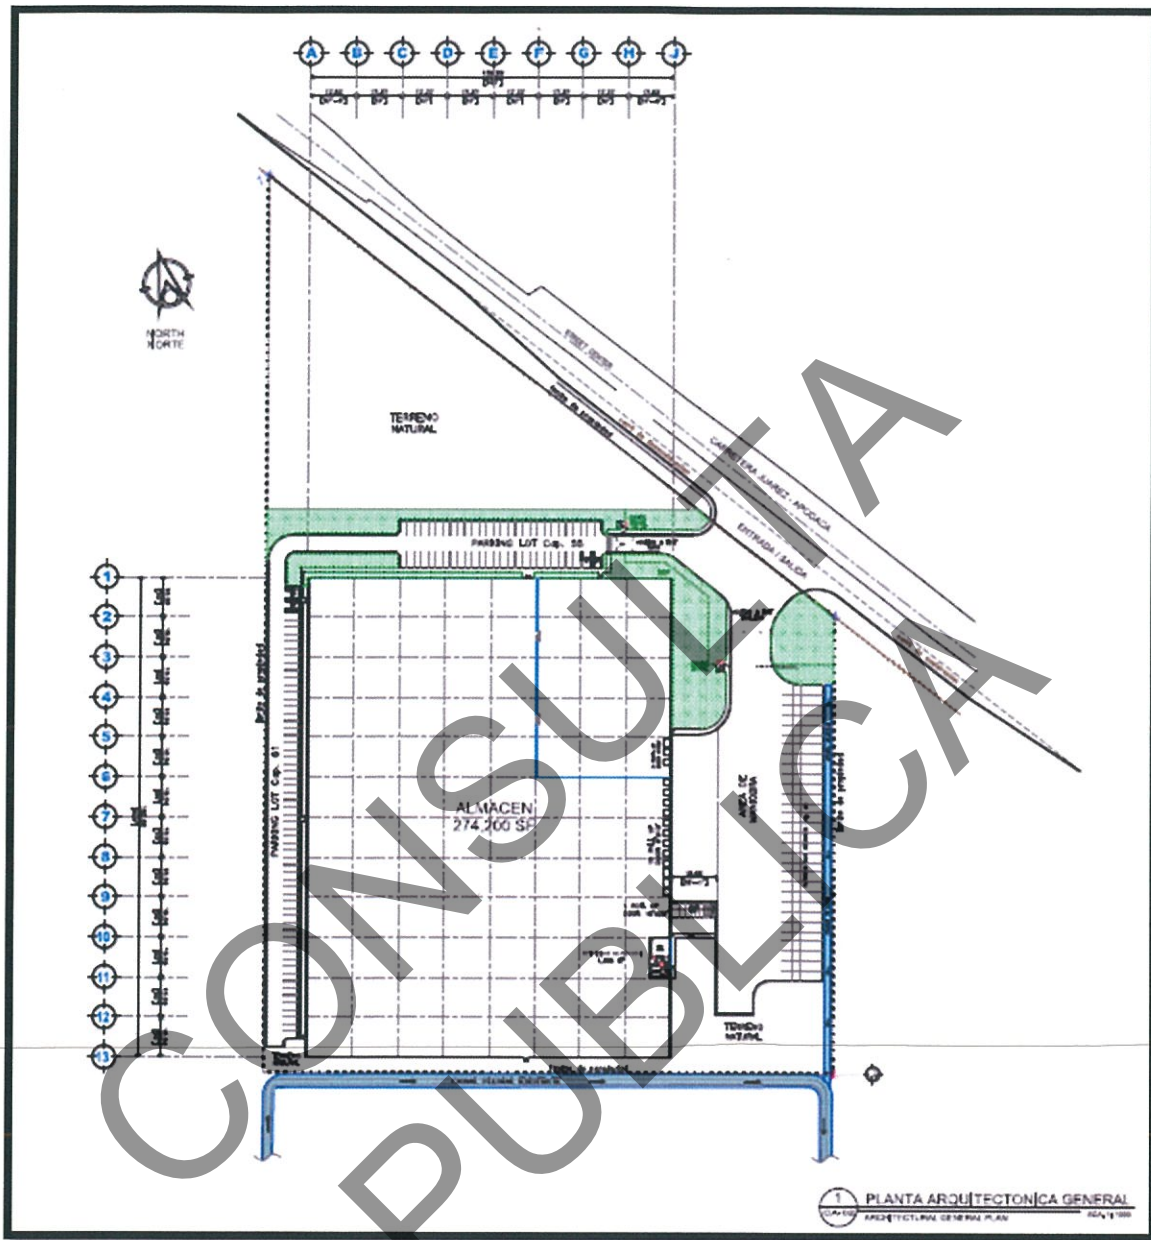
Plano vista en planta del almacén proporcionado por el cliente
